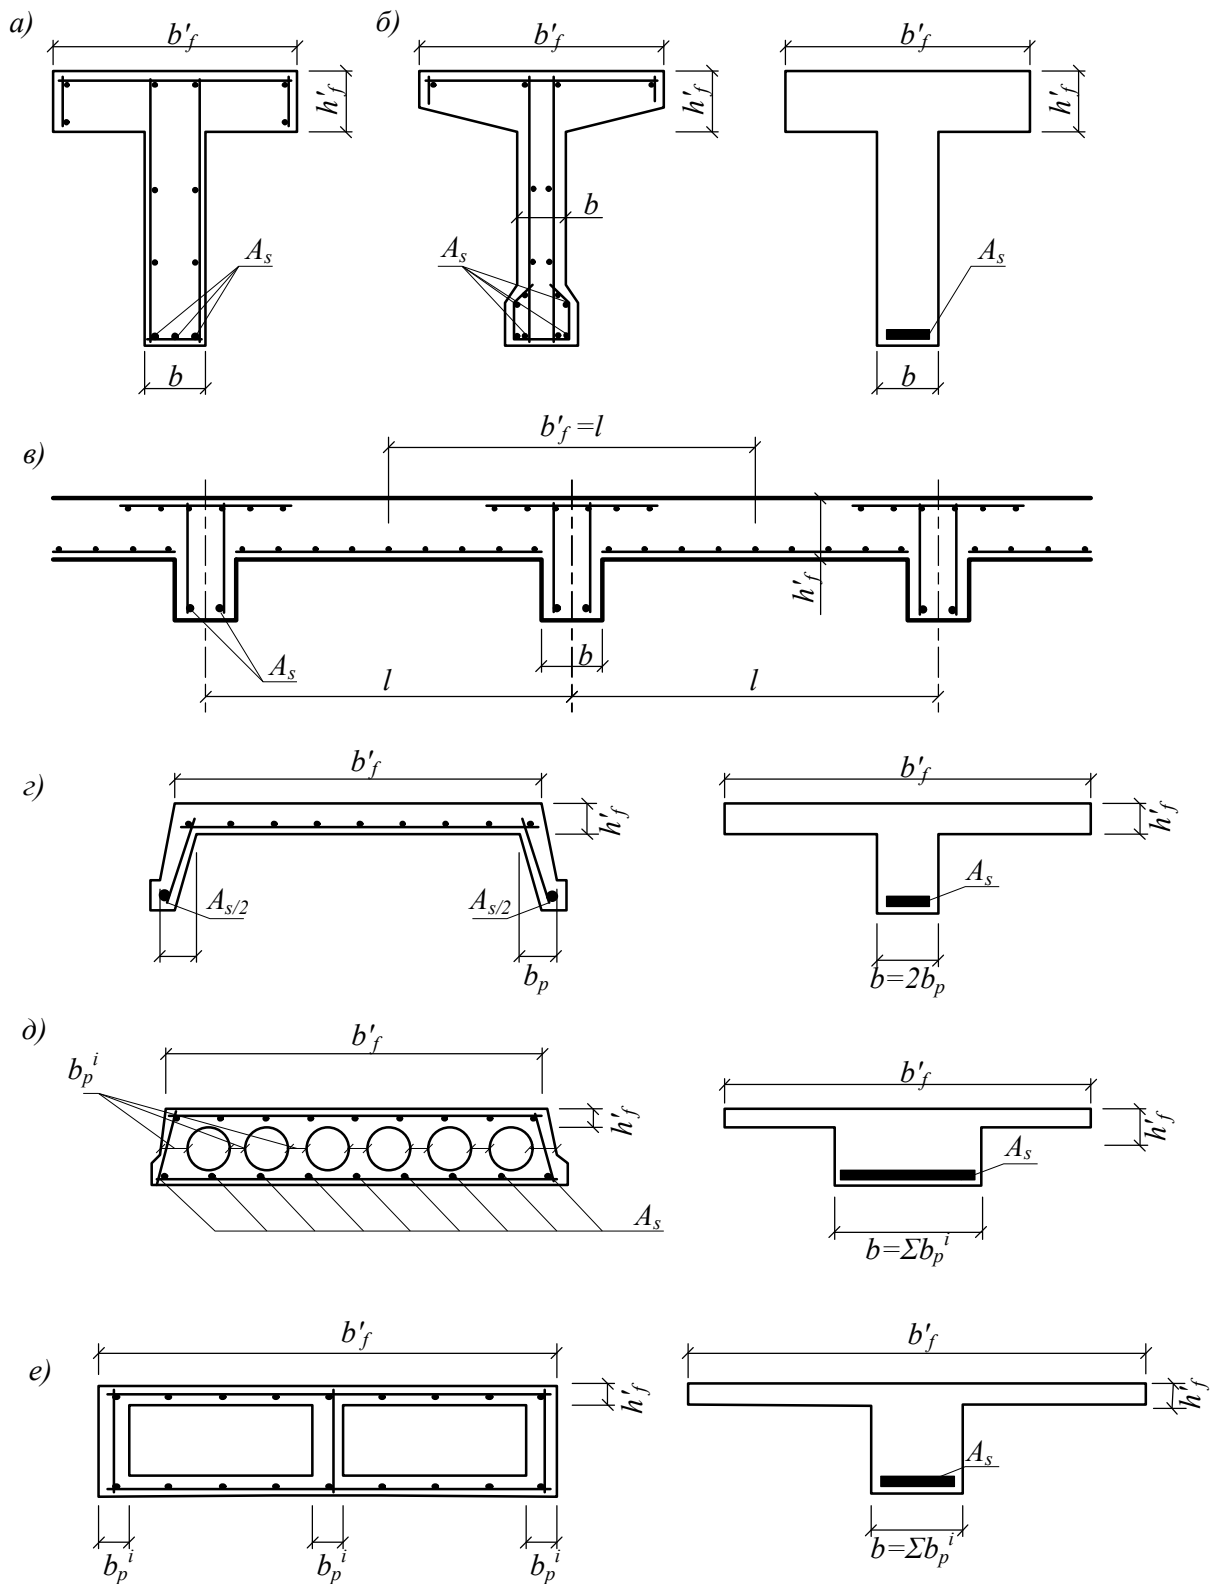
Виды железобетонных конструкций, расчет которых по прочности сводится к расчету тавра с полкой в сжатой зоне:
